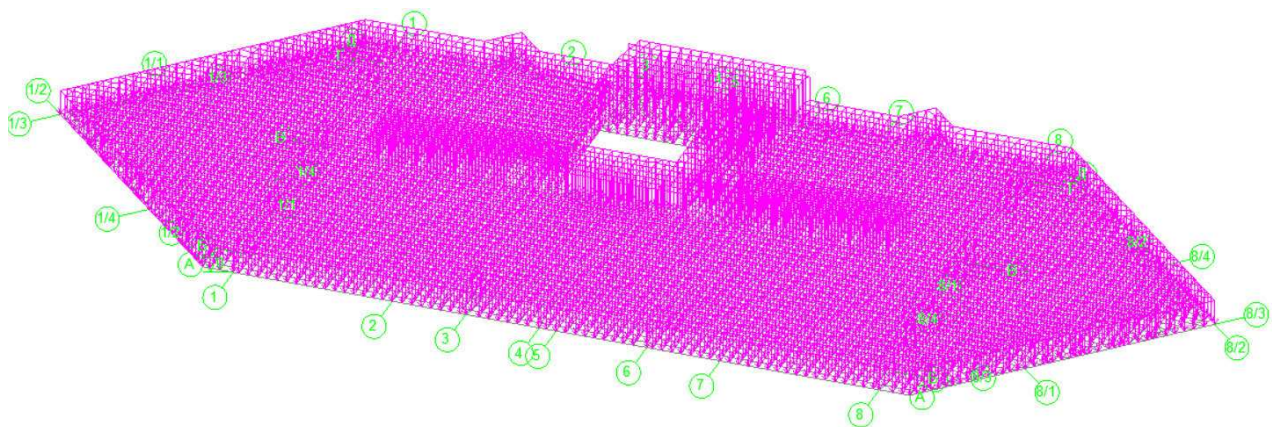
Загрузка плиты перекрытия полезной нагрузкой
